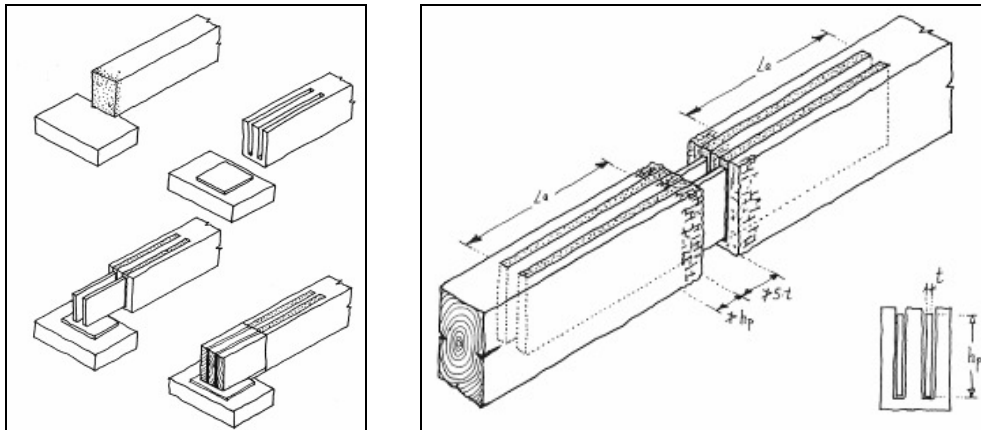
Consolidación con laminados internos de FRP. La recuperación de vigas rotas localmente, se realiza por consolidación con láminas de refuerzo introducidas en su sección.
